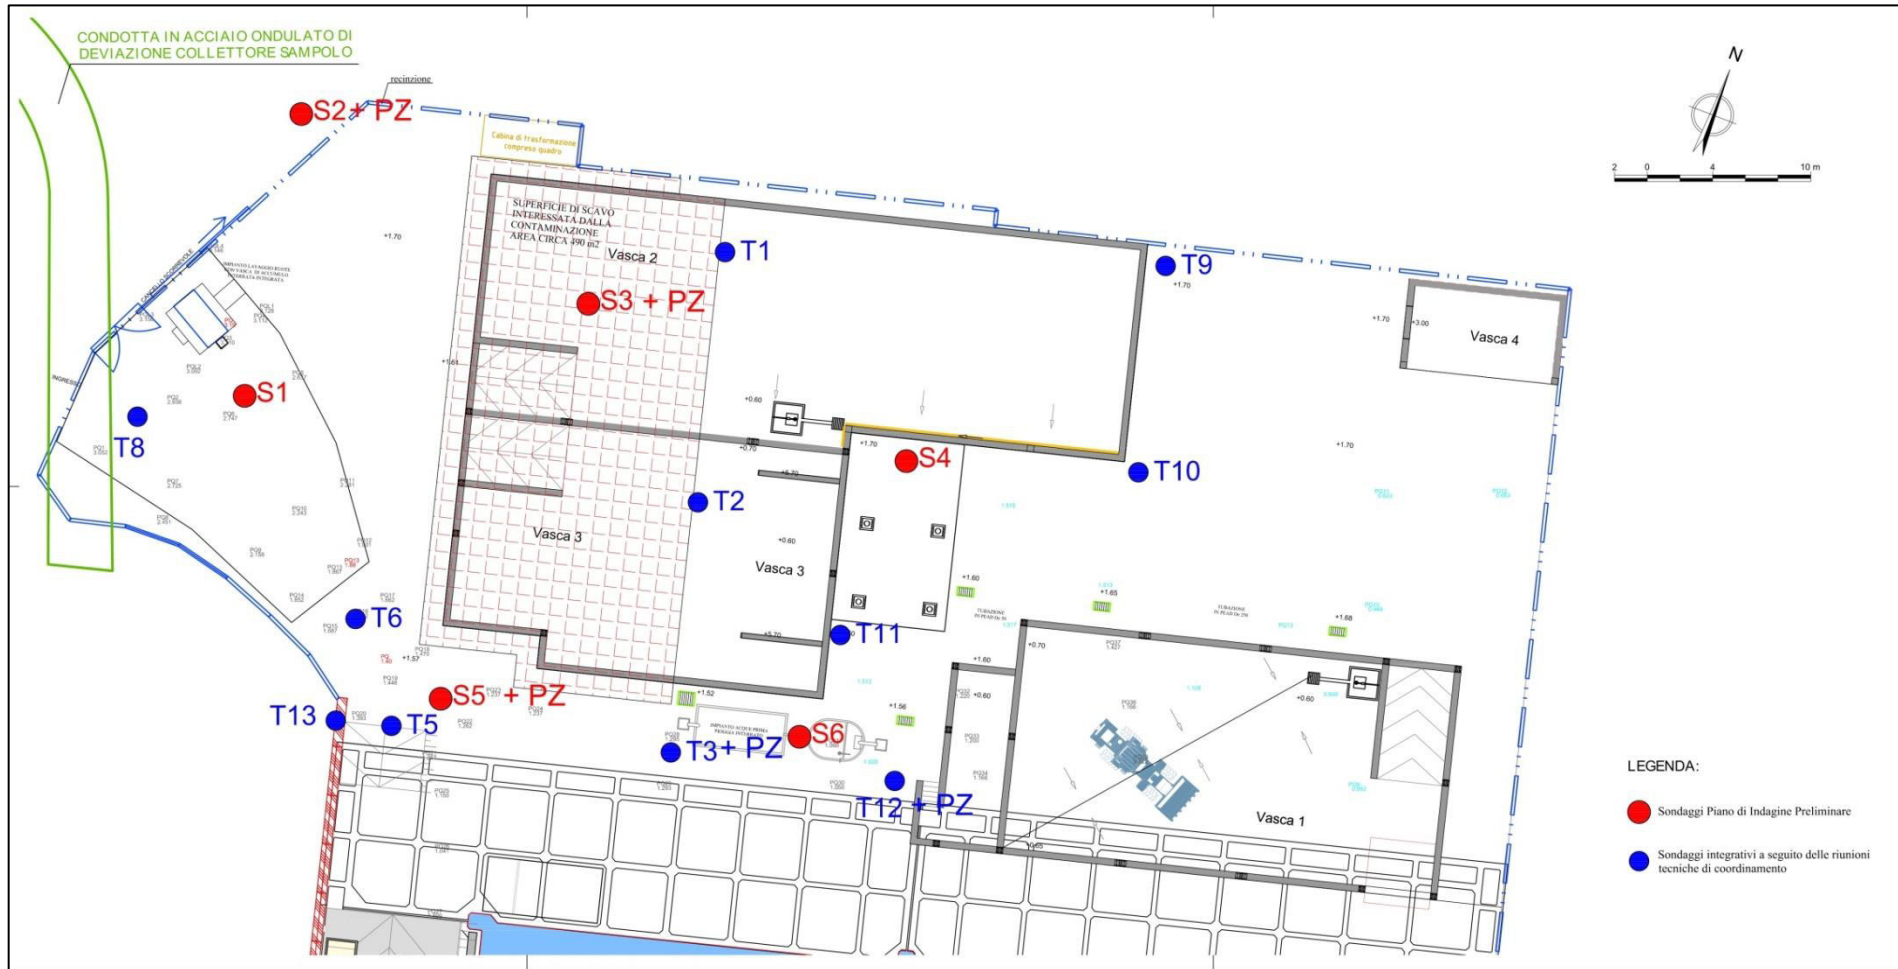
Planimetria con l'ubicazione delle indagini preliminari condotte
